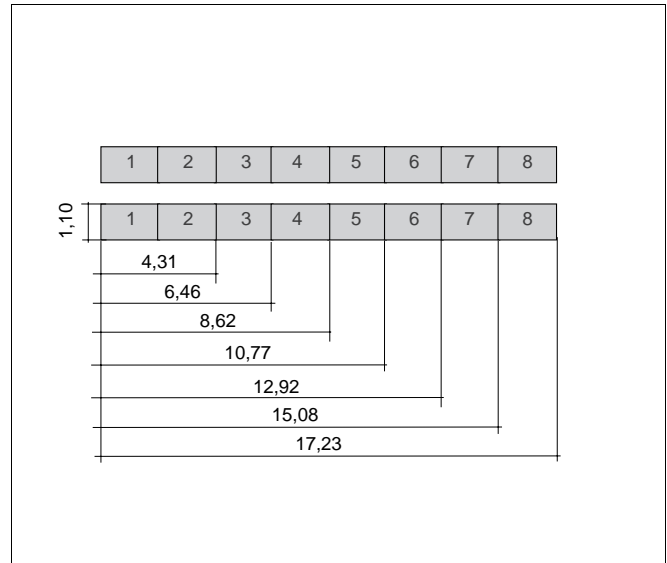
Waagerechte Ausführung (Alle Maße in mm)
